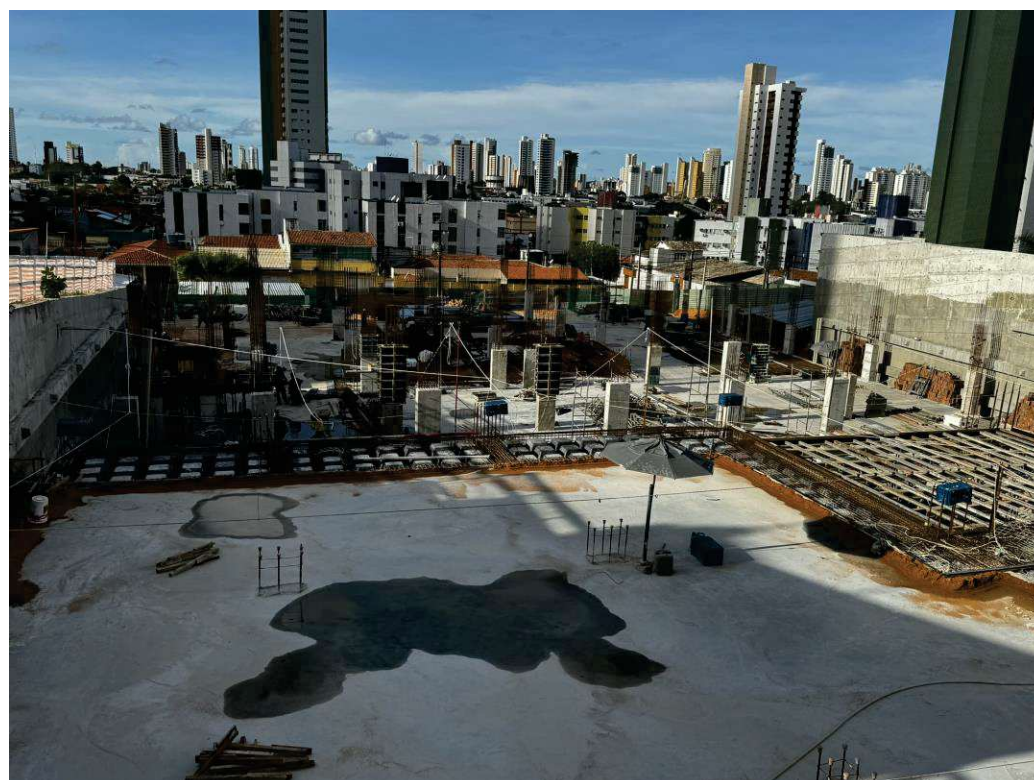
Laje do de cobertura do segundo subsolo concretada.
